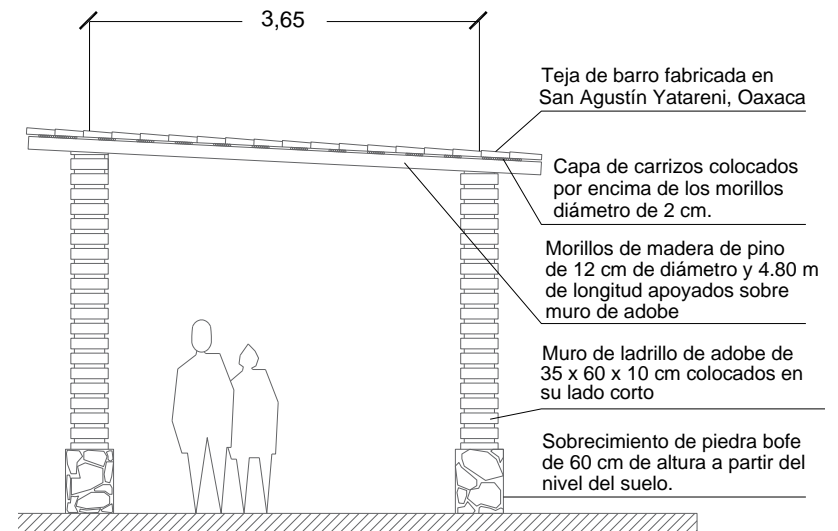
Elaboración propia con datos del Laboratorio de Procedimientos y Sistemas Constructivos Tradicionales. Corte por fachada. Vivienda vernácula en San Jerónimo Tlacoahuaya, Oaxaca.
